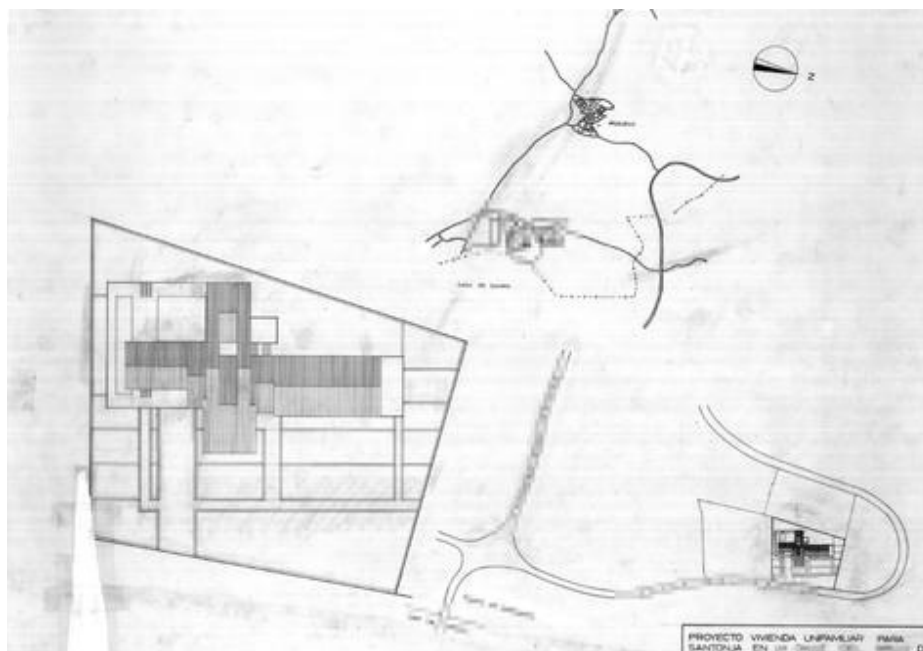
Plano Planta de situación general en parcela, con esquema de situación en Madrid y en la Colonia de Trofas.
